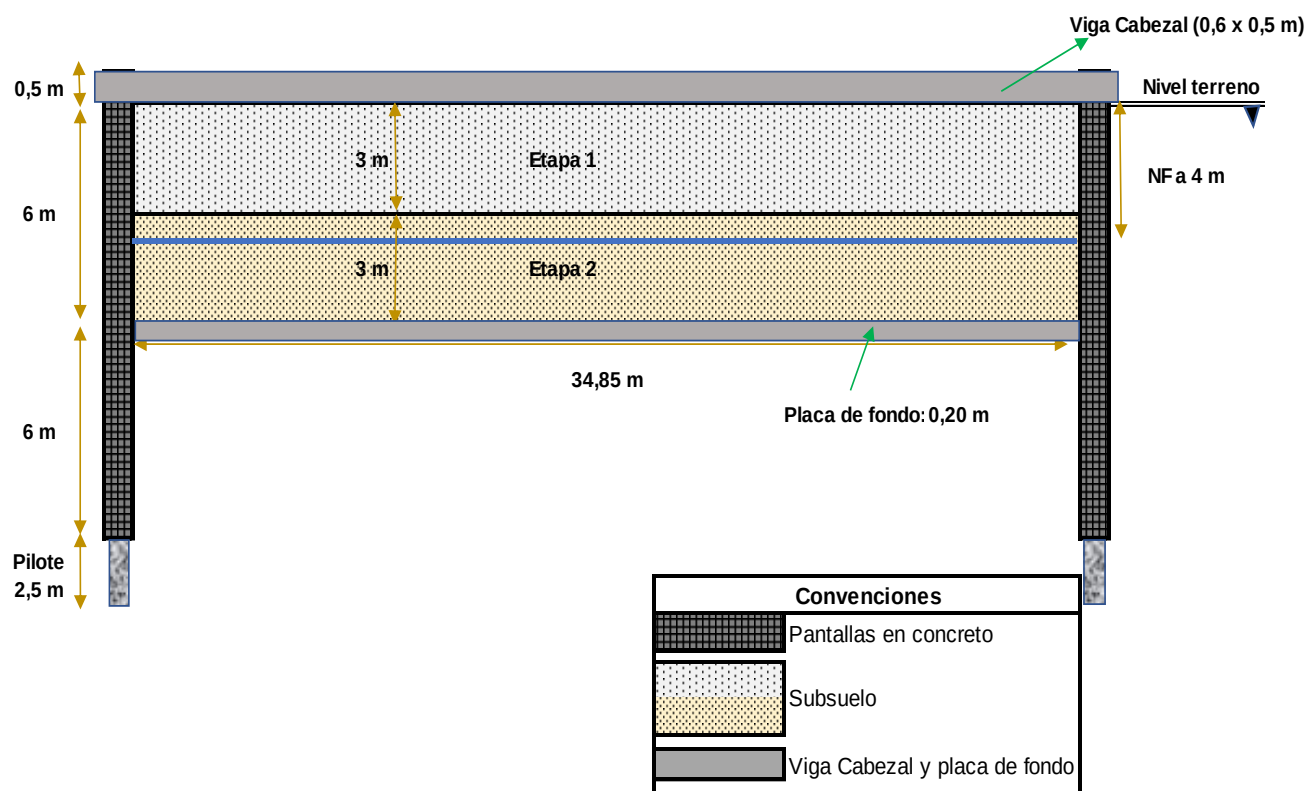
Sección transversal secuencia excavación deprimido Américas con calle 26
